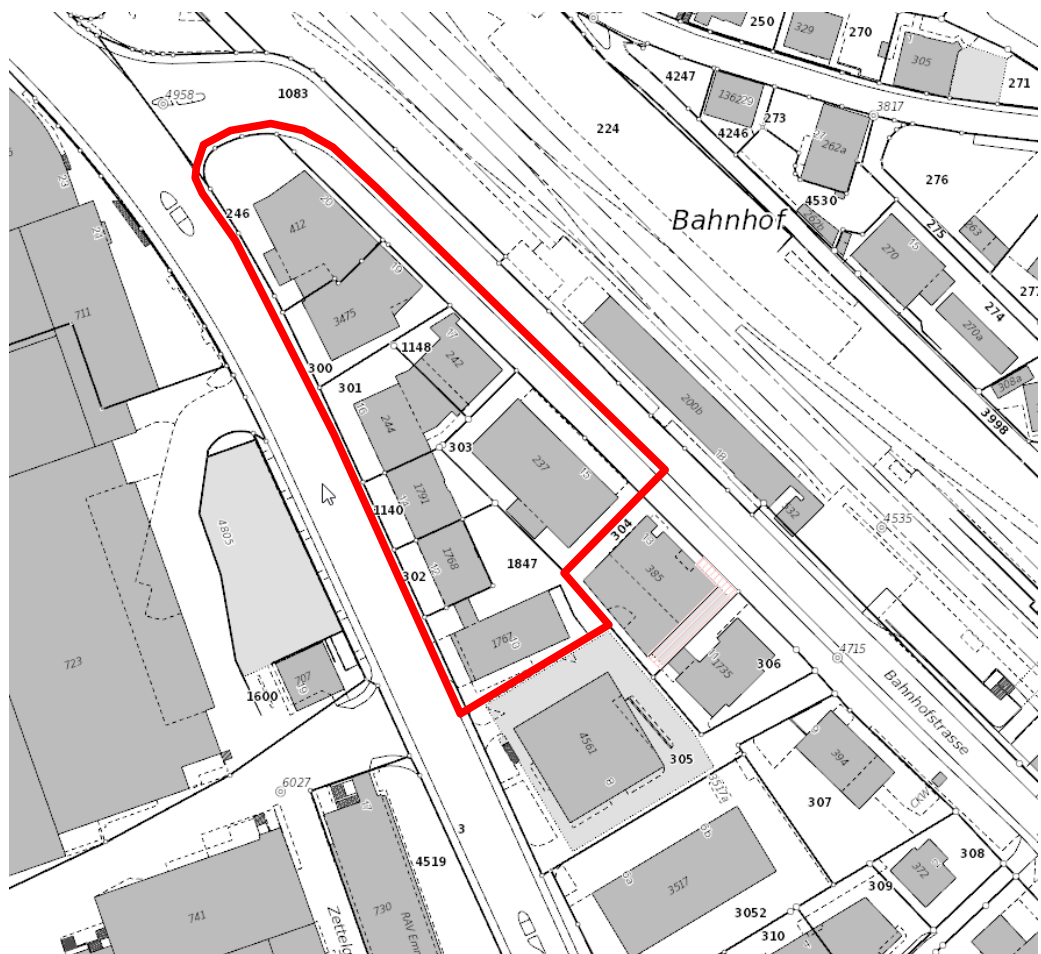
Situationsplan mit Planungspereimeter (rot)
